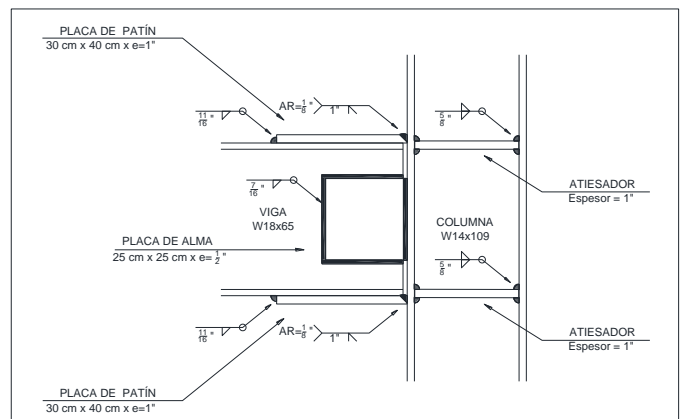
Requerimiento de diseño por el FEMA 350 para el diseño de la conexión por medio de placas soldadas para la probeta CM-FP\_01.
